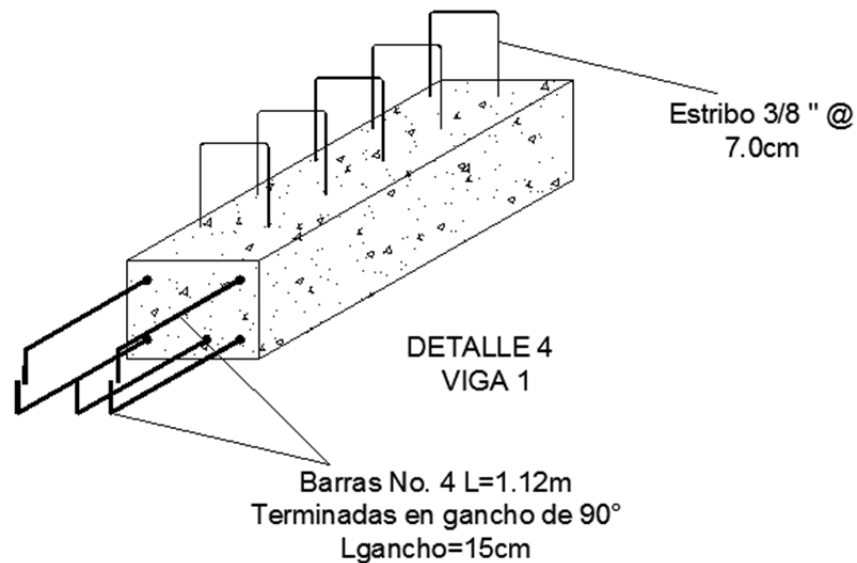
Detalles del refuerzo suministrado en la viga de borde
